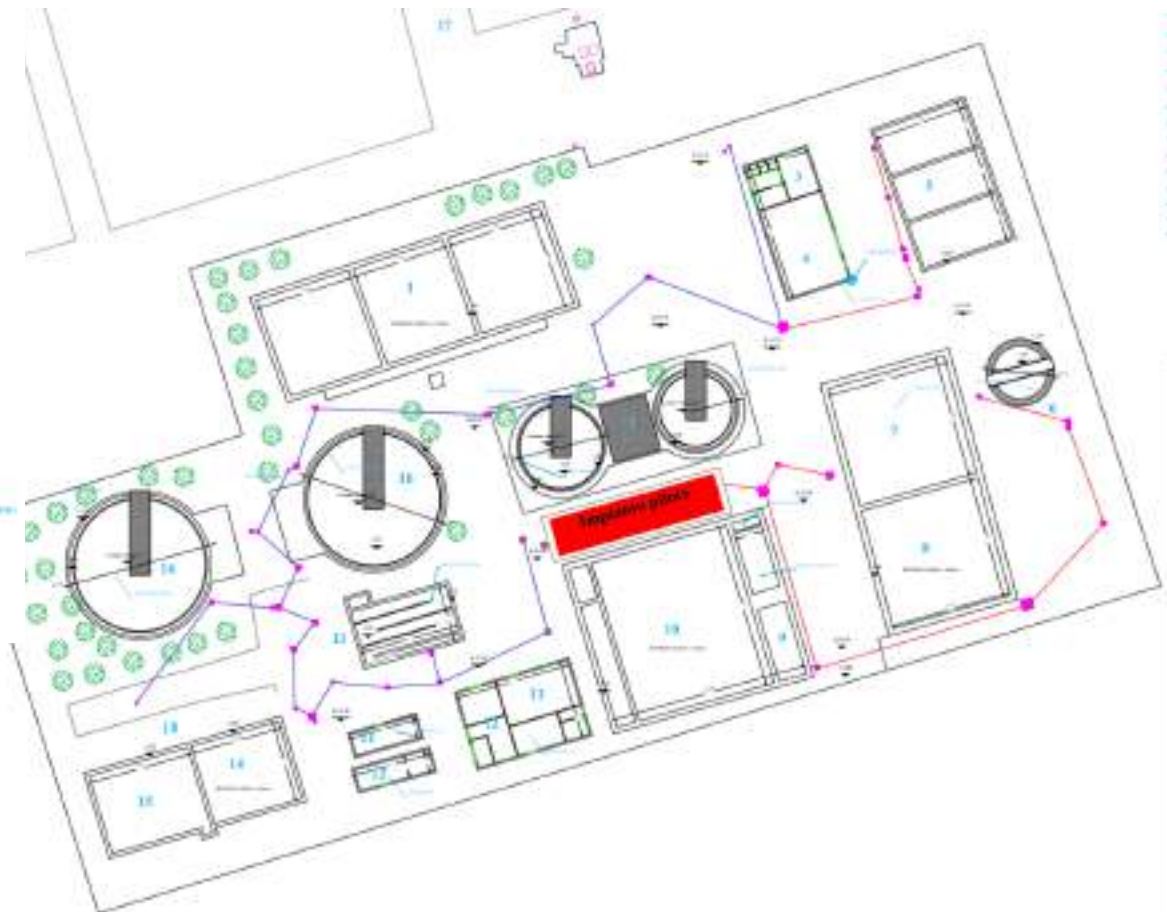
layout impianto di depurazione Vernole con ubicazione impianto pilota
